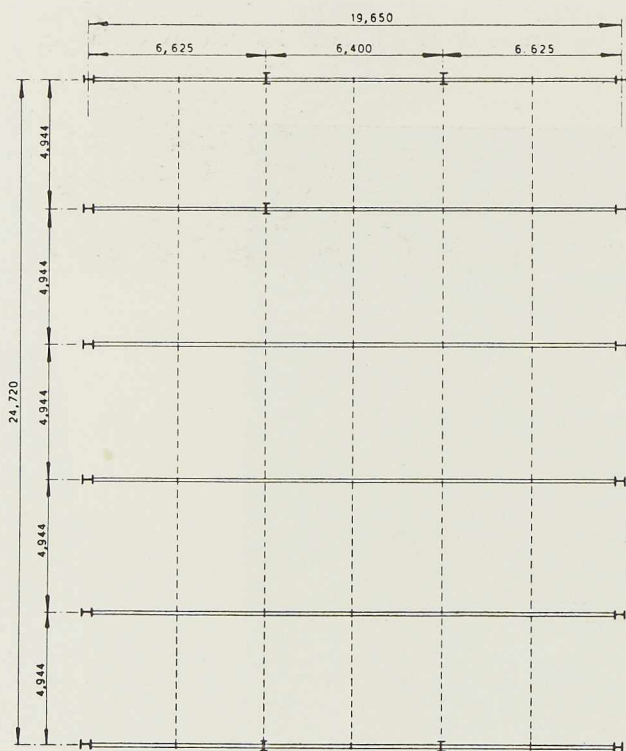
Vue en plan de l'ossature en acier du pavillon.
